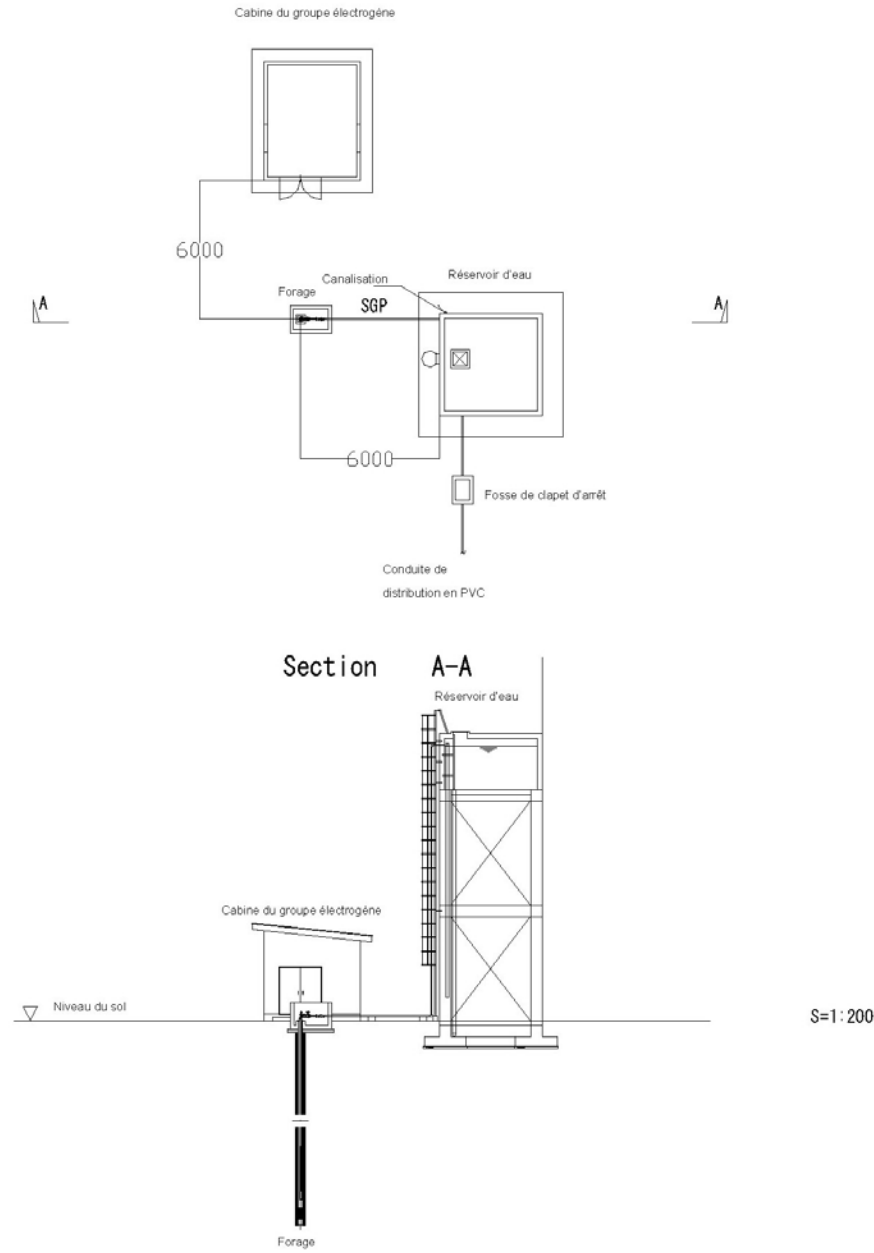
Plan de site d'une installation hydraulique de niveau 2
